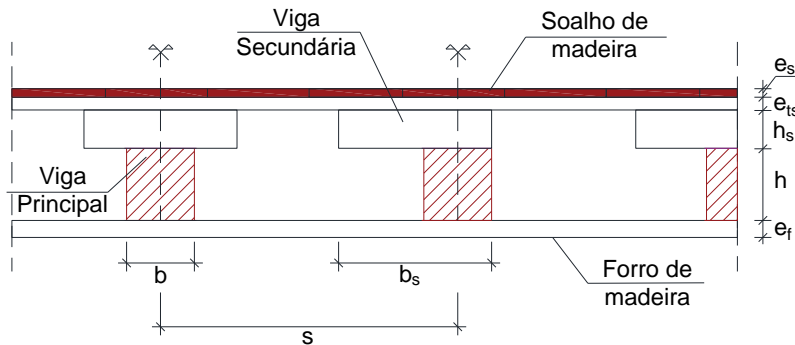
Secção média dos elementos de madeira que compõem o pavimento 2 (Pav. 2 – S1.2)
